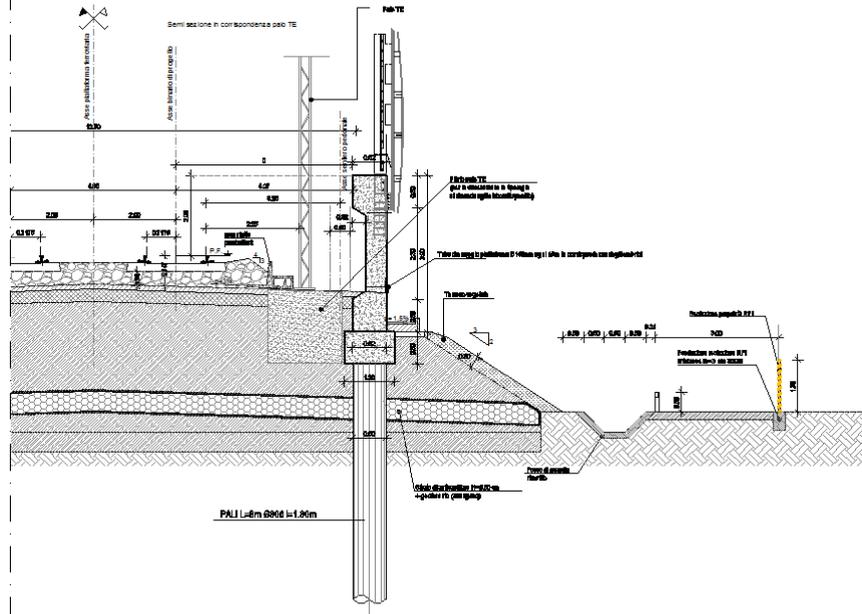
Sezione trasversale muro di protezione tipo A
